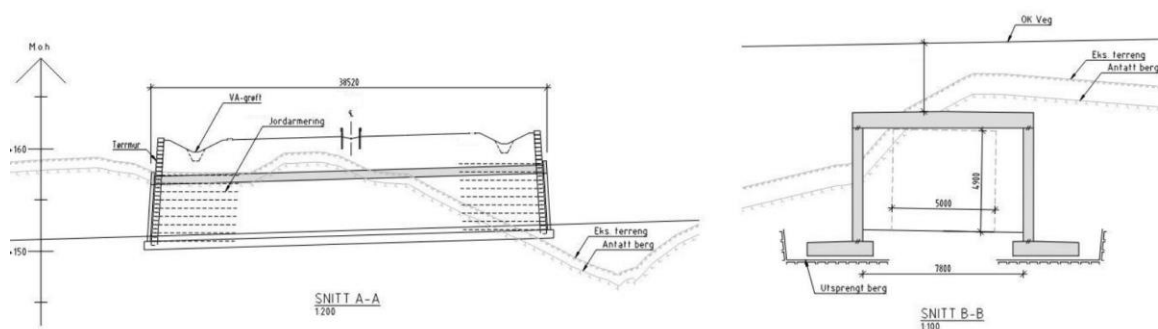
Savannbrua – to parallelle betongkassebruer for korridor 40
